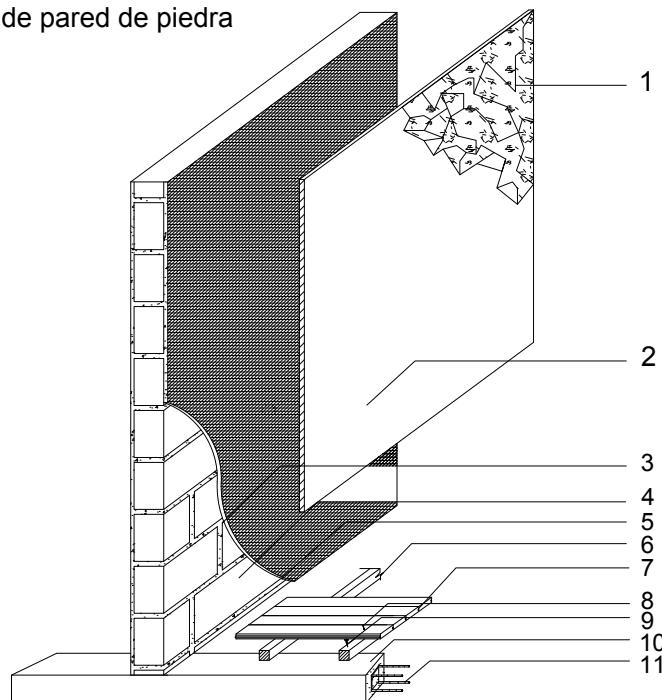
Detalle pared de piedra. (Romero, 2018).
